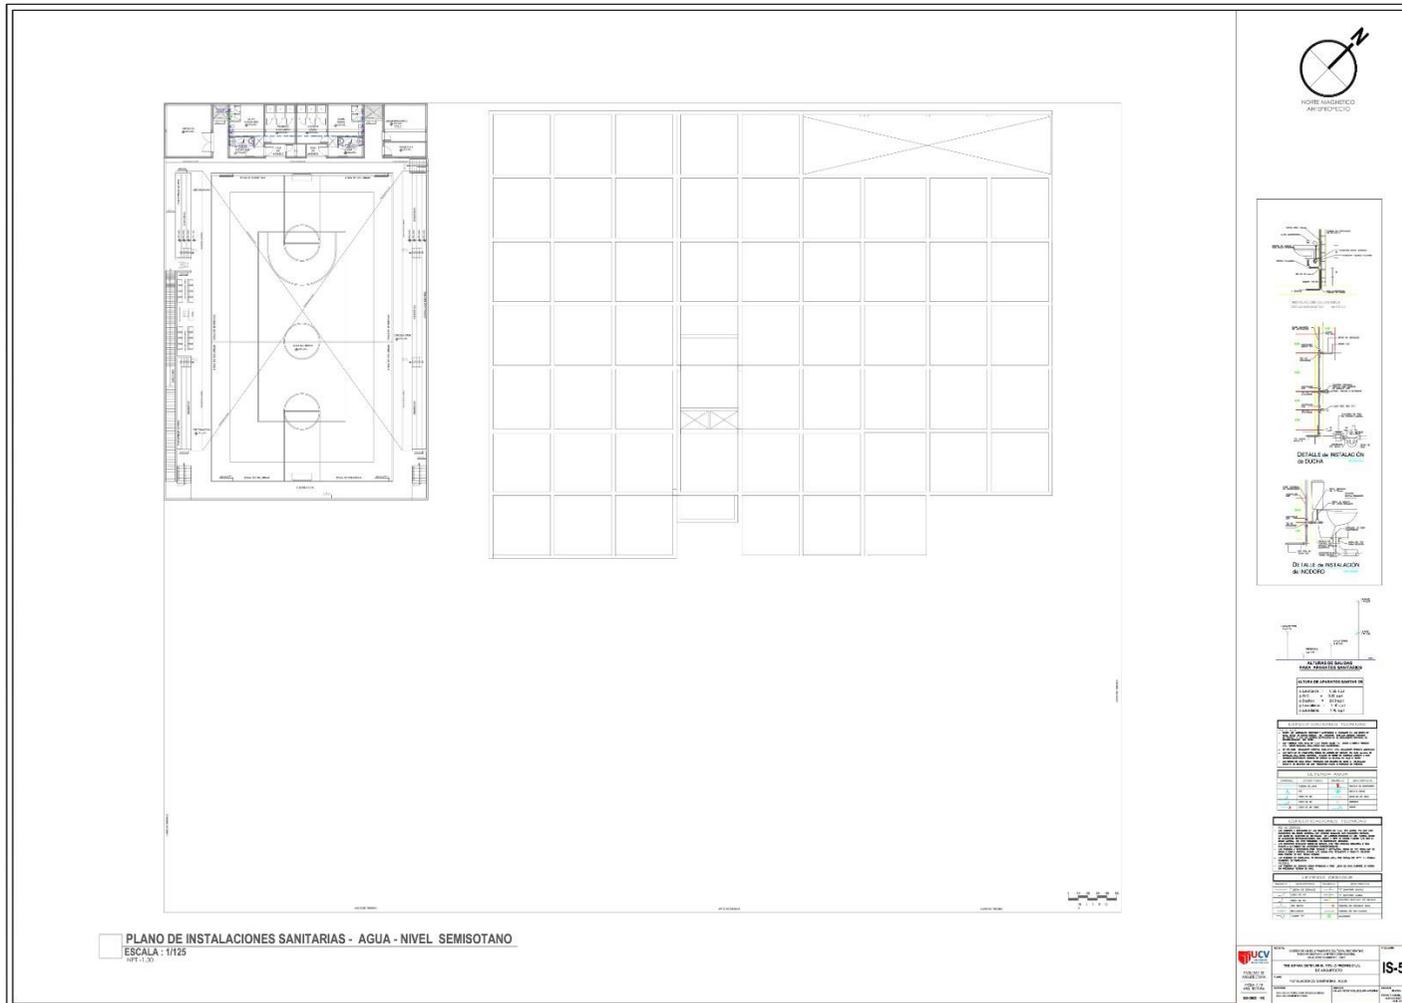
Plano de Instalaciones Sanitarias Nivel Semi Sótano
